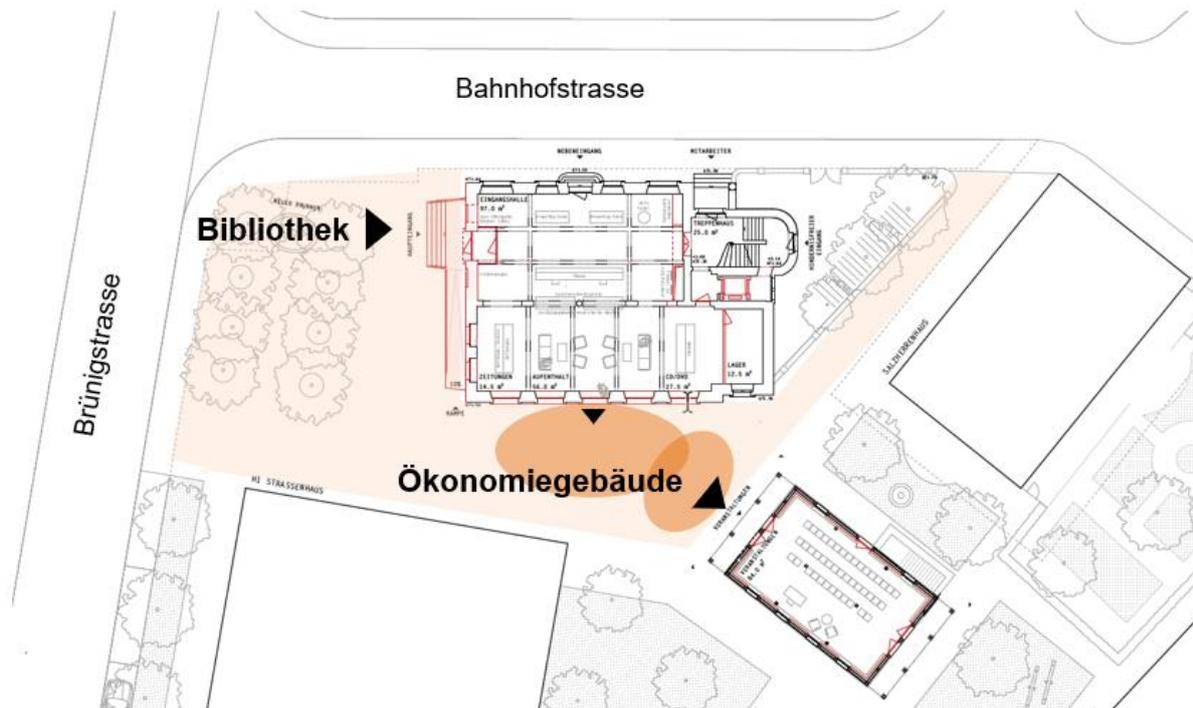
Grundriss der geplanten Kantonsbibliothek mit westseitigem Haupteingang und Lesegärten im Süden.
